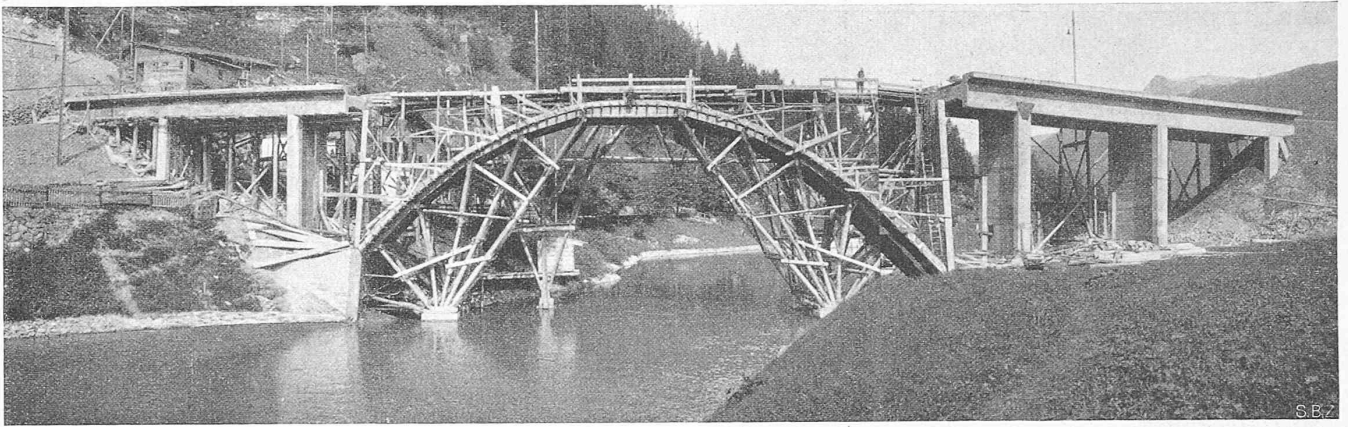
Gesamtbild der Brückenbaustelle über dem Staubecken; Anschluss-Viadukte vollendet. Bauausführung Prader & Cie., Zürich.
